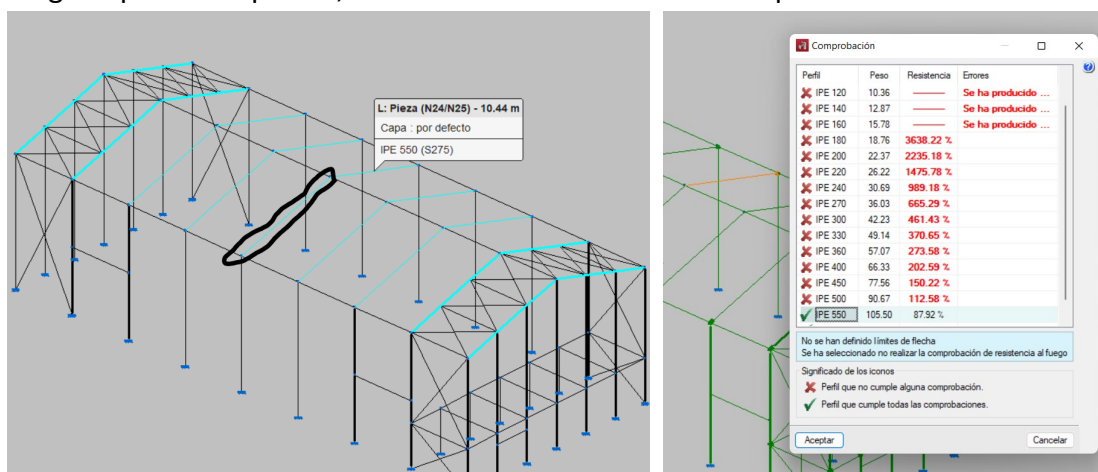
Evaluación de perfiles para la viga de pórtico más desfavorable
